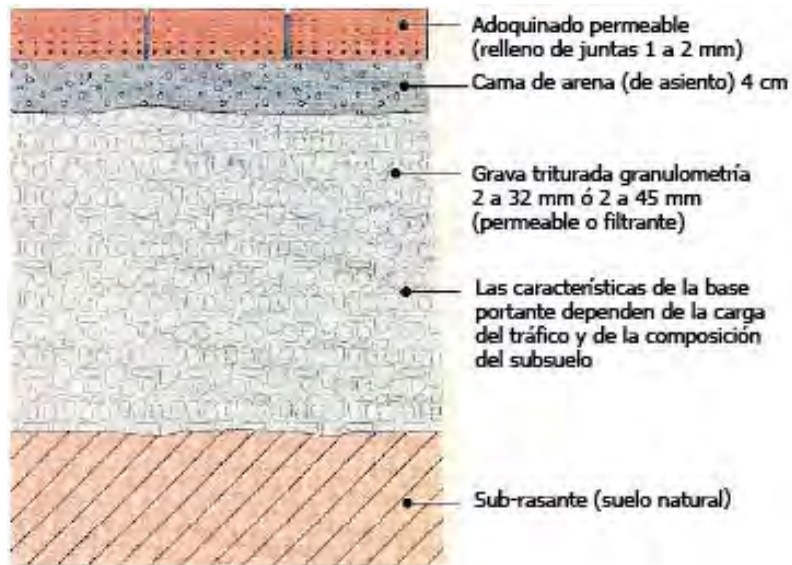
PAVIMENTO PARA BANQUETAS, ANDADORES Y VIALIDADES a base de adoquines de concreto permeable. - Fuente: Revista Le Moniteur, Jun. 1996, p. 76
